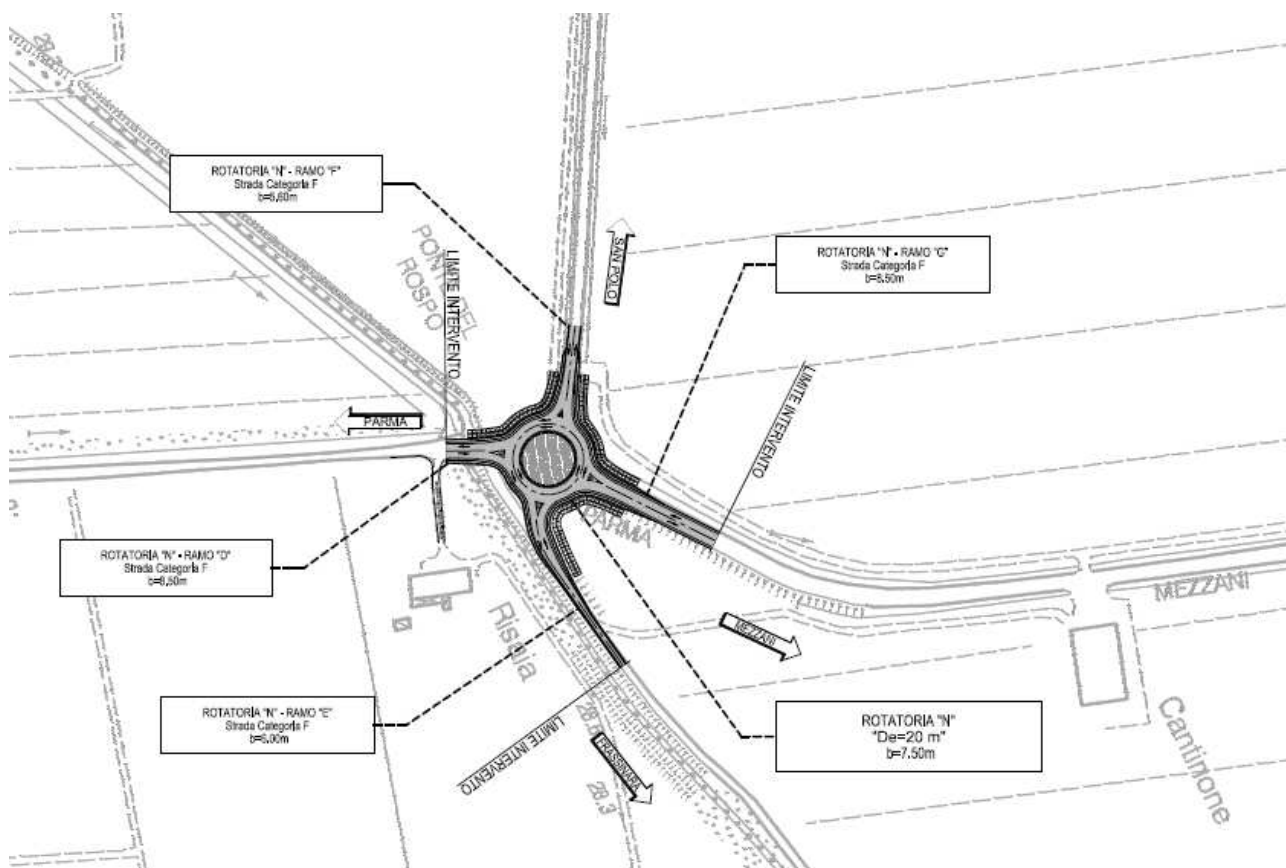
PLANIMETRIA DI PROGETTO – TRATTO 2 - OPERA D01 (EX 1PR)
